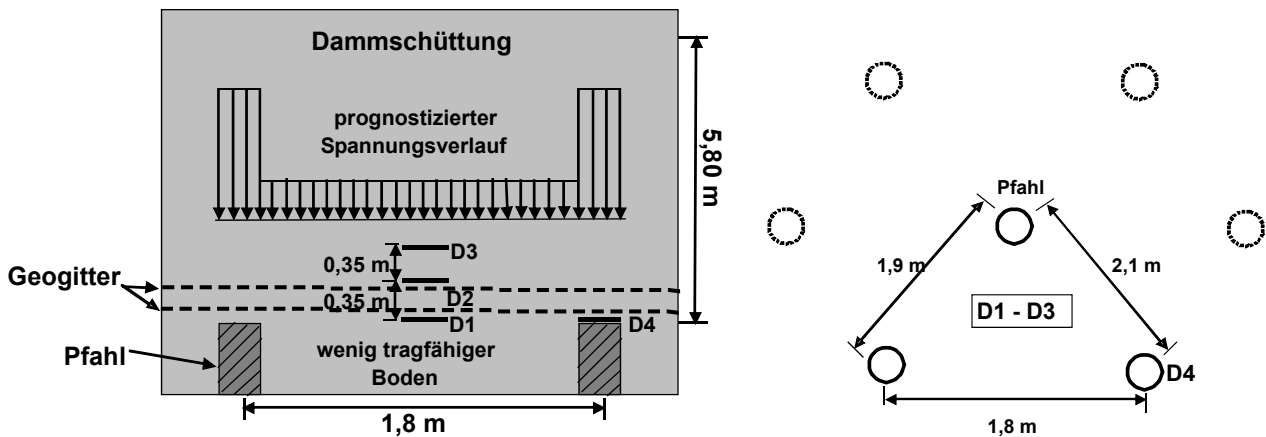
Schematische Darstellung der Spannungsausbildung, Grundriss des Messbereiches
